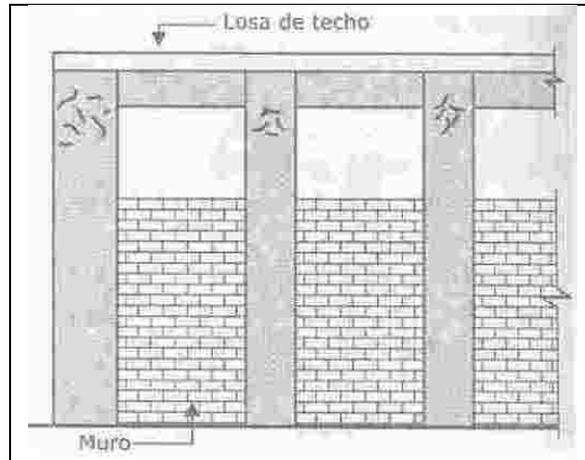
Fisuras o roturas en la cabeza de columnas cortas¹⁹
